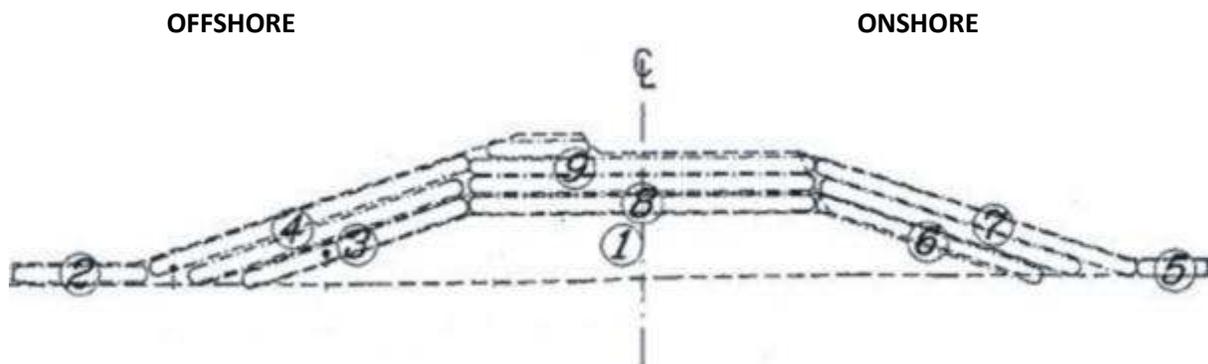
Contoh denah dan potongan melintang konstruksi pemecah gelombang
